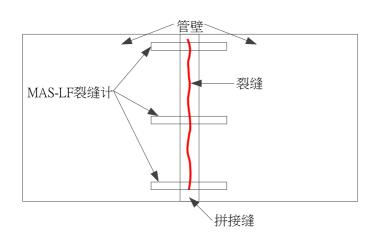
MAS-LF裂缝计传感器布设示意图(平面图)
